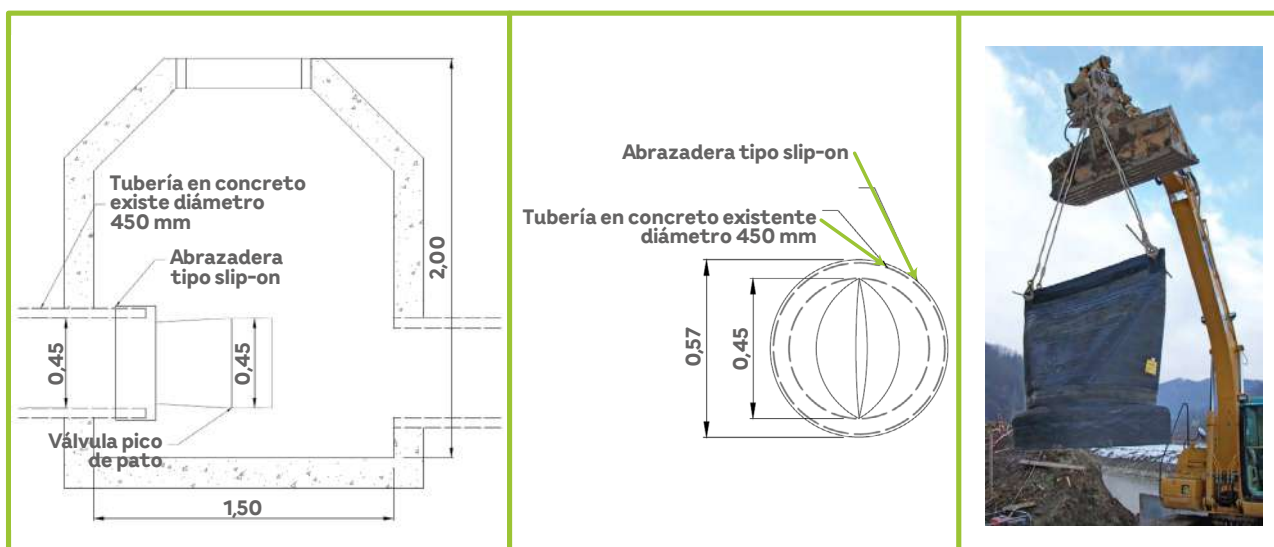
Construcción de MH e instalación de válvula pico de pato.
